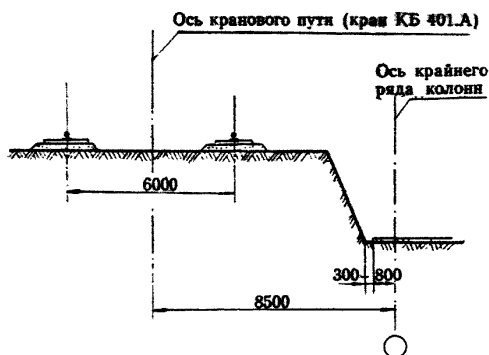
Схема привязки башенного крана КБ–401.А к осям сооружения при бетонировании фундаментной плиты
